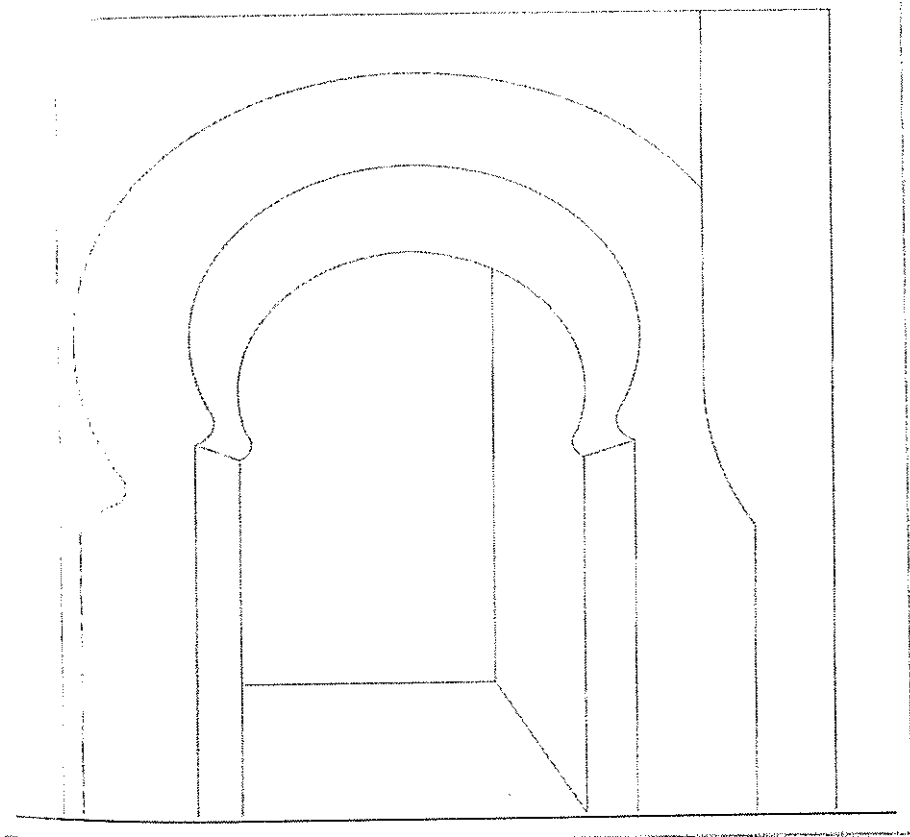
مسقط أفقي كروكي لأجزاء من حيس قارة، عمل الباحث.
